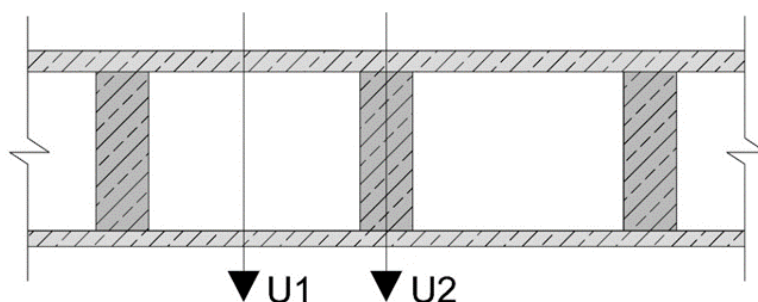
Solução construtiva do pavimento em estrutura de madeira.
